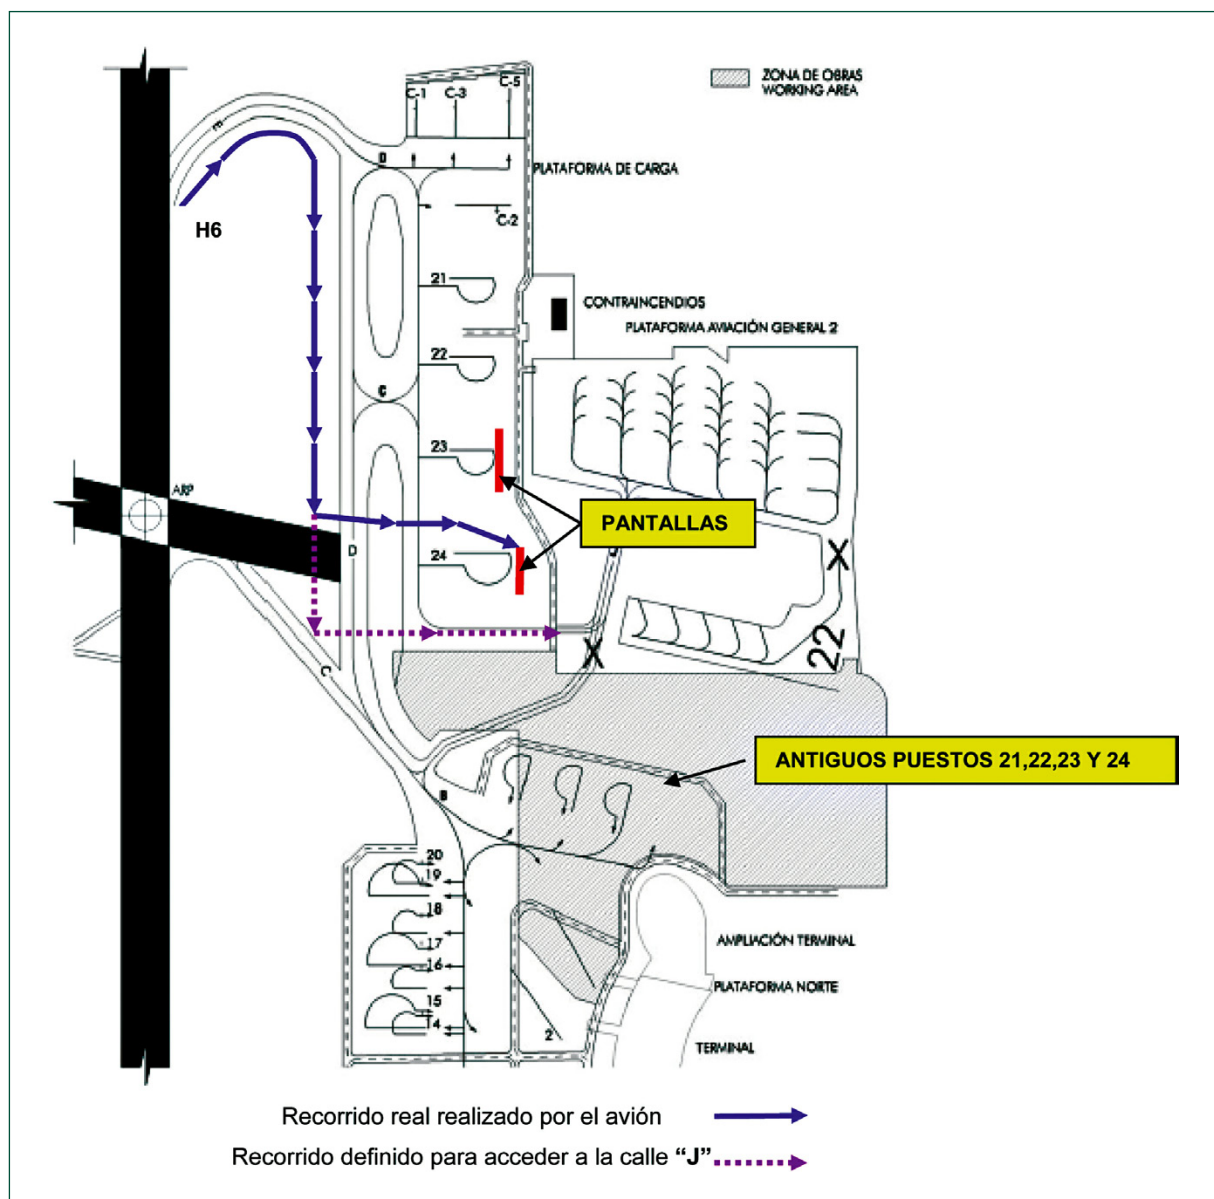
Recorrido de la aeronave en tierra (plano Fase III de las obras)
